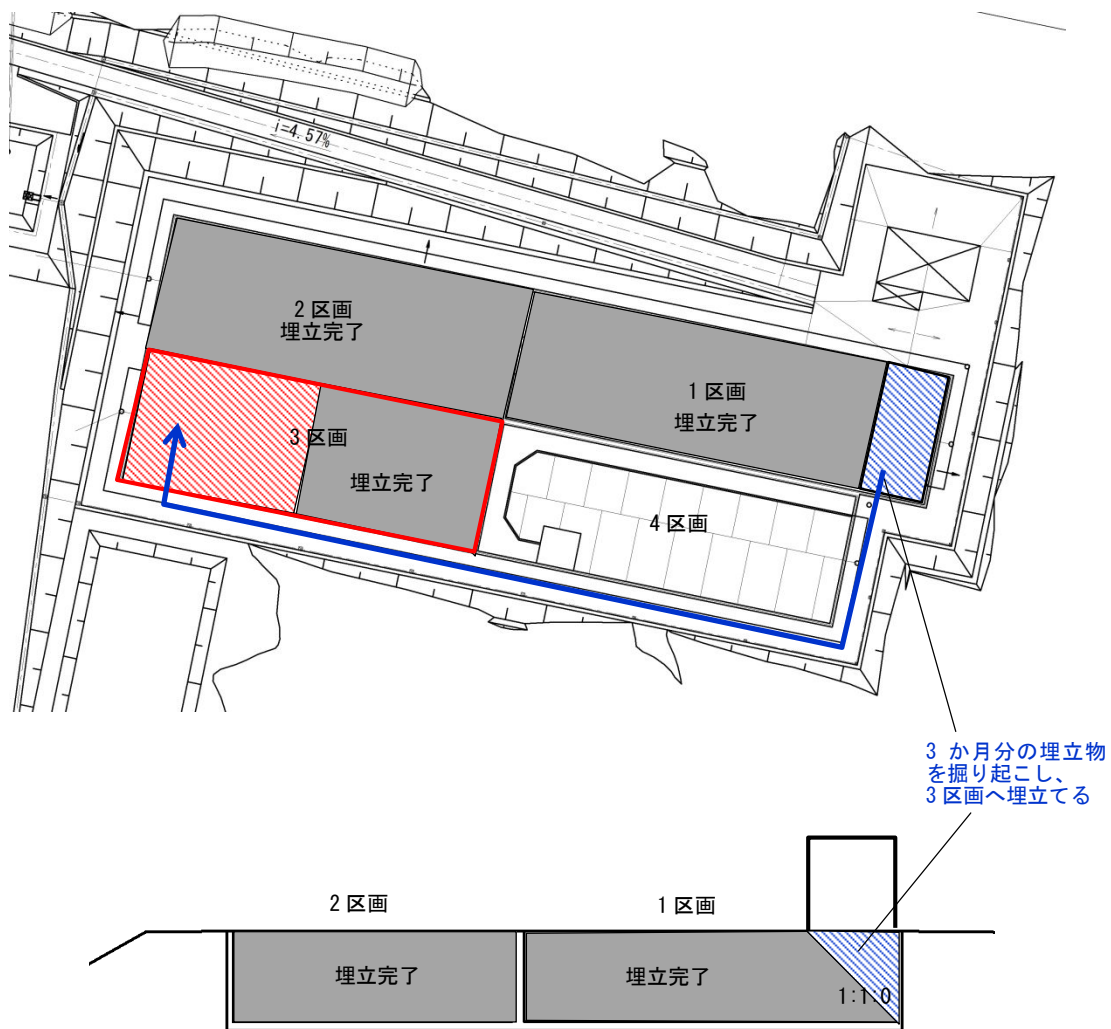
埋立地平面図・標準断面図 (3回目・上屋移設時①)
